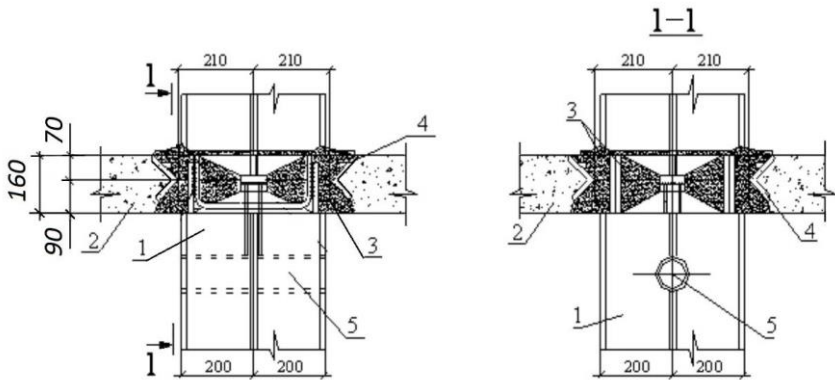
Конструкція шпонкового вузла з'єднання колони з надколонною плитою: 1 – колона; 2 – плита; 3 – бетонна шпонка; 4 – сталеві обичайки отвору плити; 5 – отвір для монтажу плити
